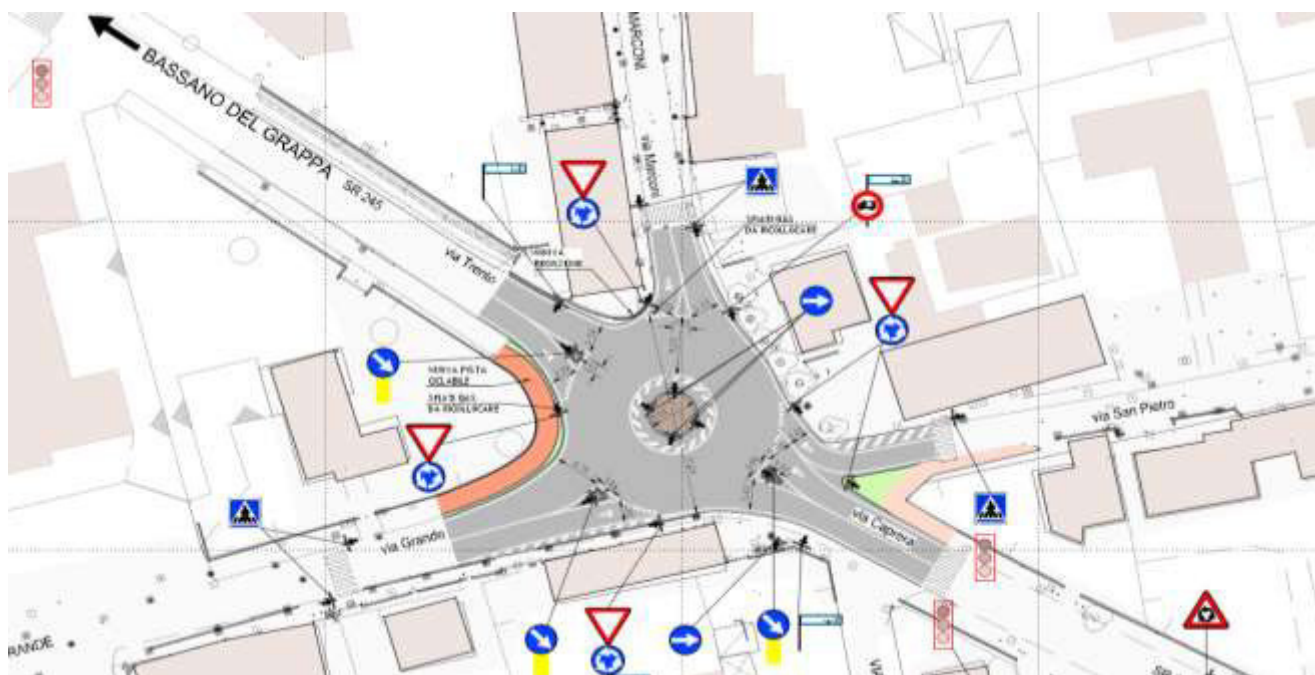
Planimetria di progetto con indicazione della nuova segnaletica.
